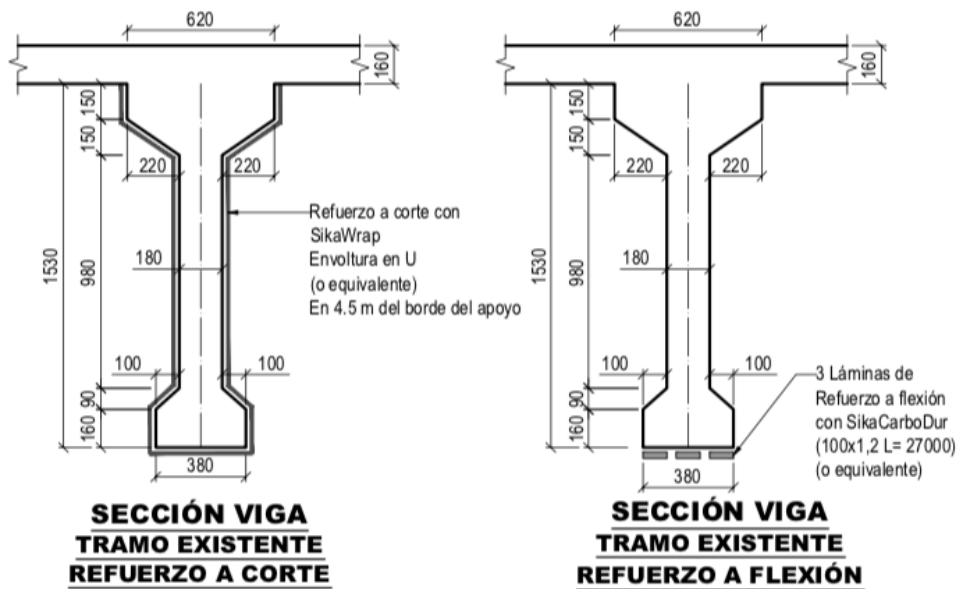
Propuesta de reforzamiento para las vigas, Sección Transversal
